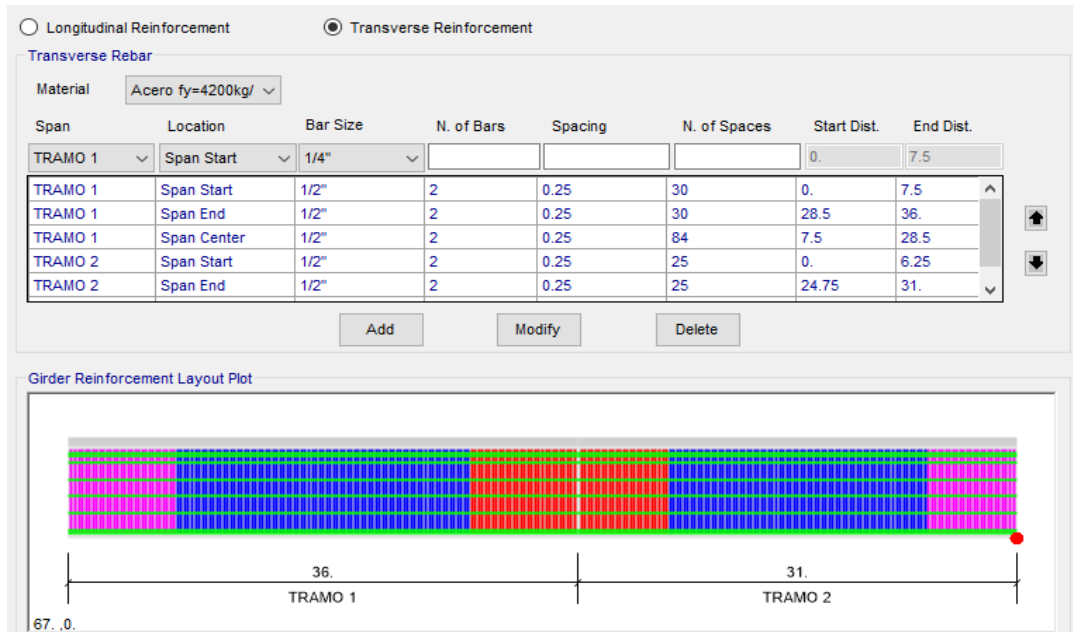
Distribución del acero de refuerzo transversal (estribos)
